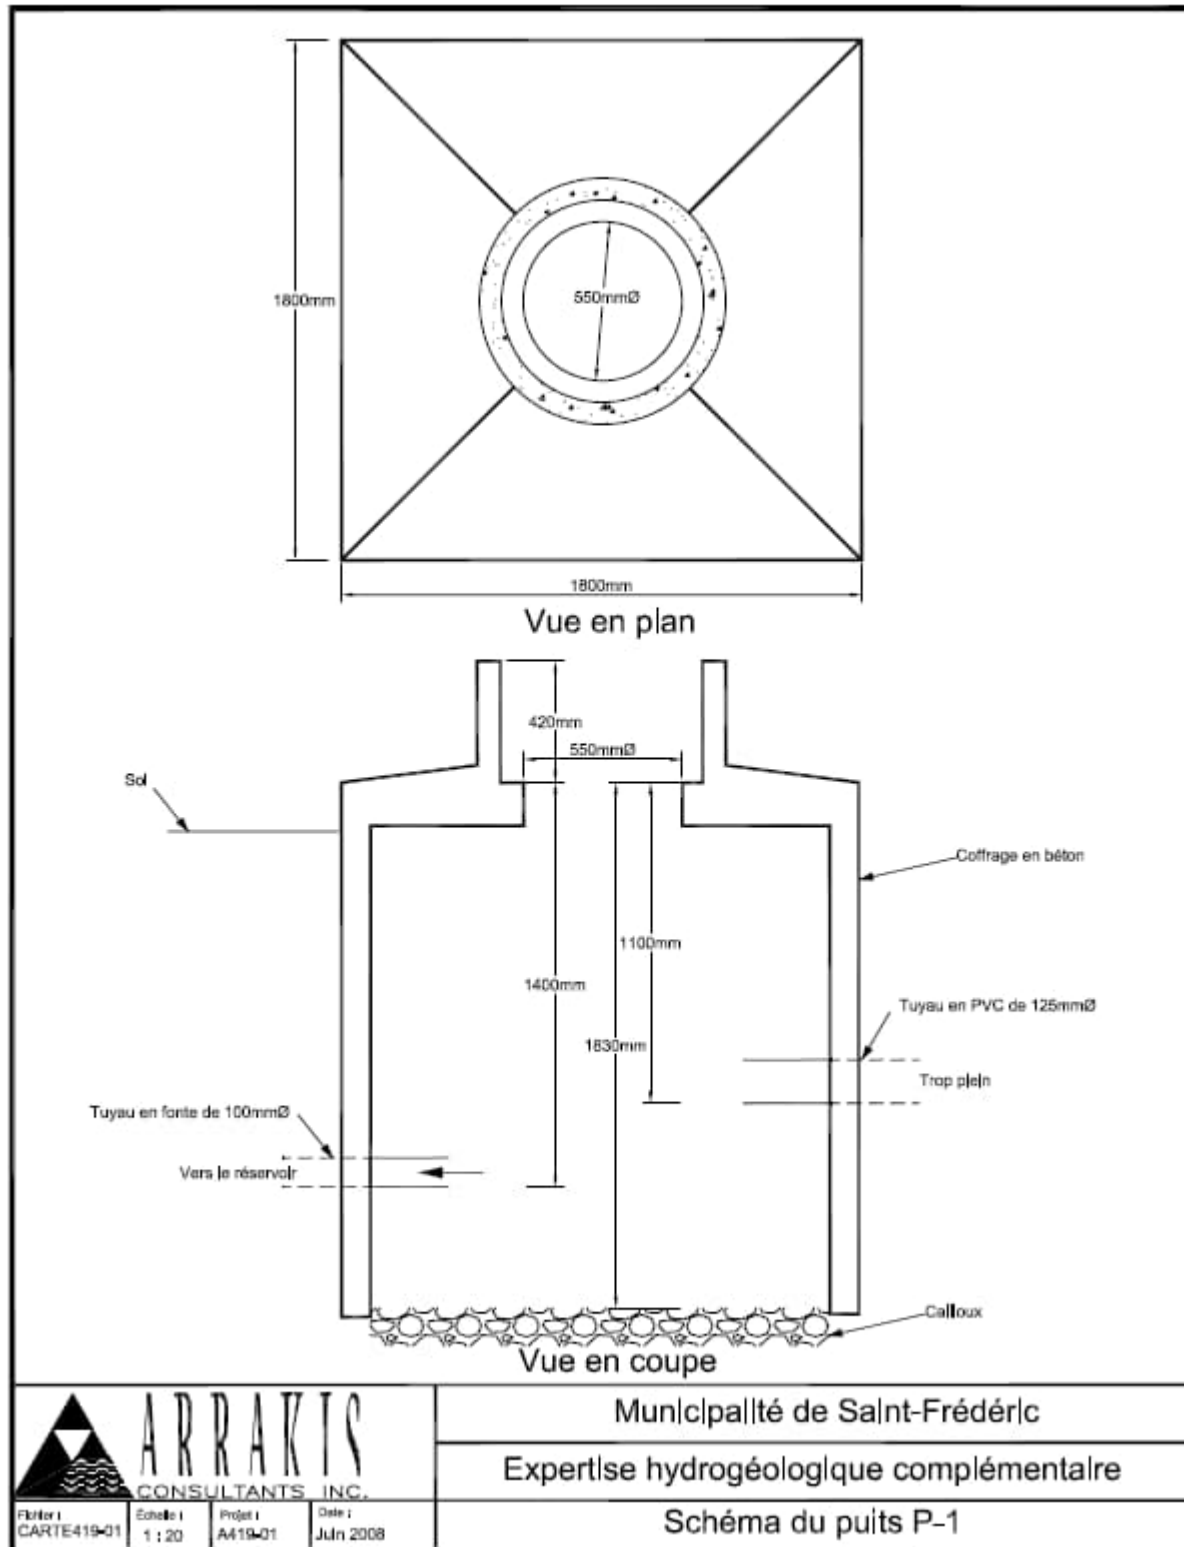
Vue en coupe de la construction de l'installation de prélèvement X2002616-4 (puits P-1)
